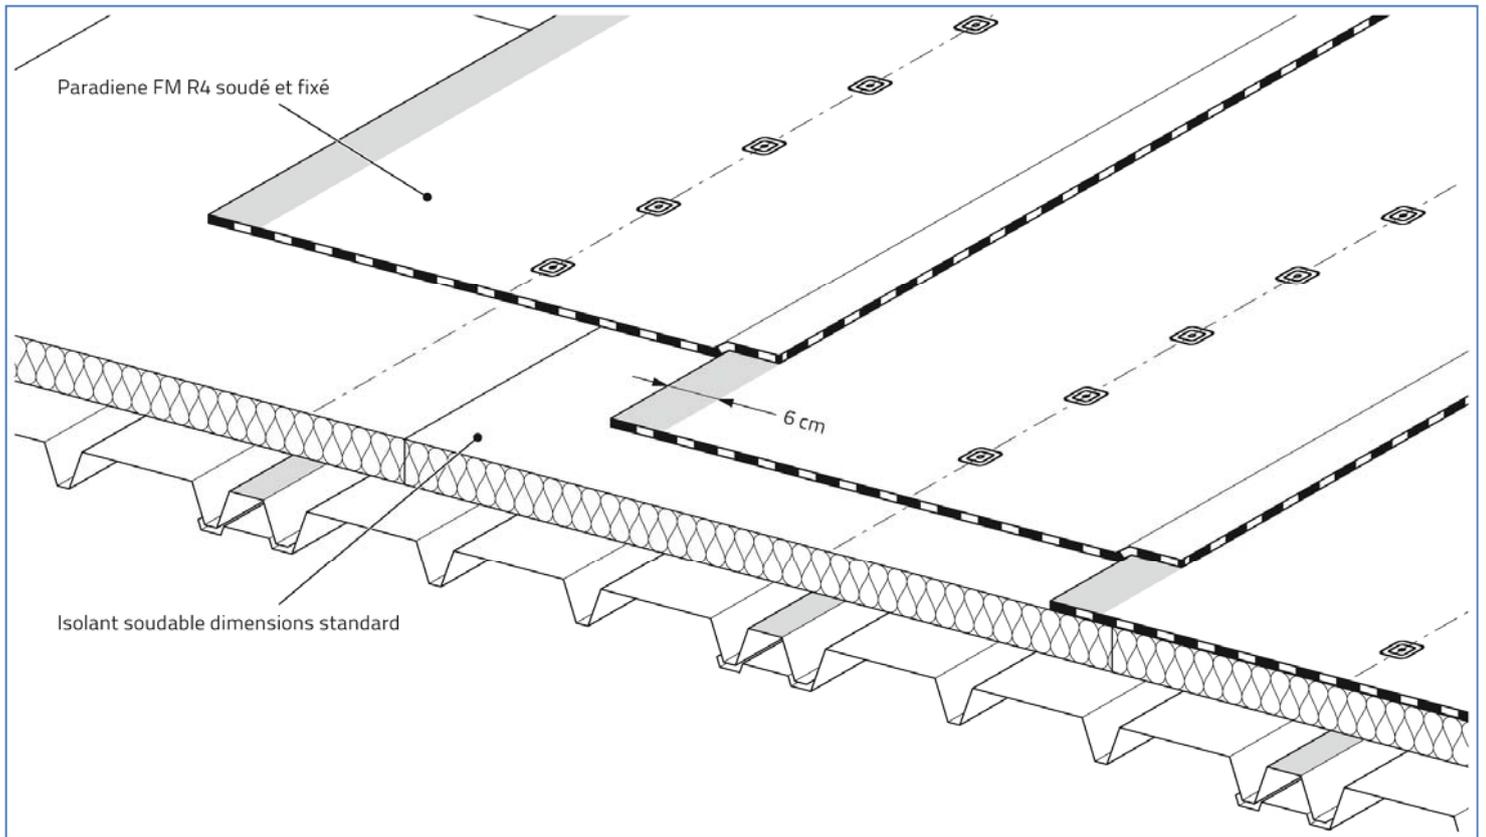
Revêtement d'étanchéité bicouche soudé et fixé mécaniquement (avec bandes de pontage)
